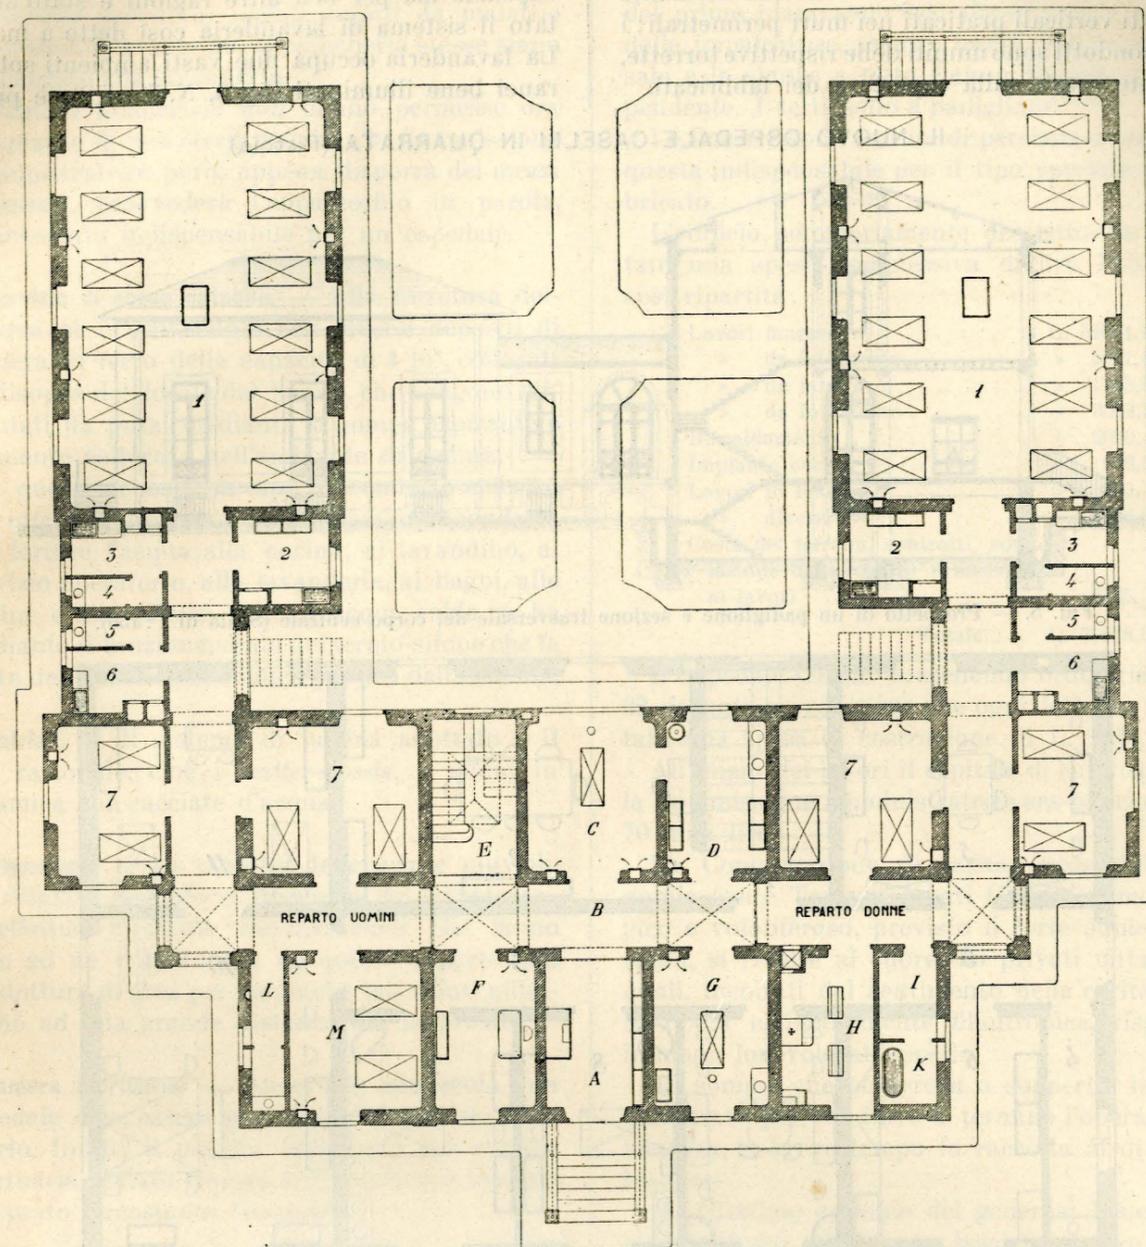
Pianta del piano terreno (Scala di 1:220).
